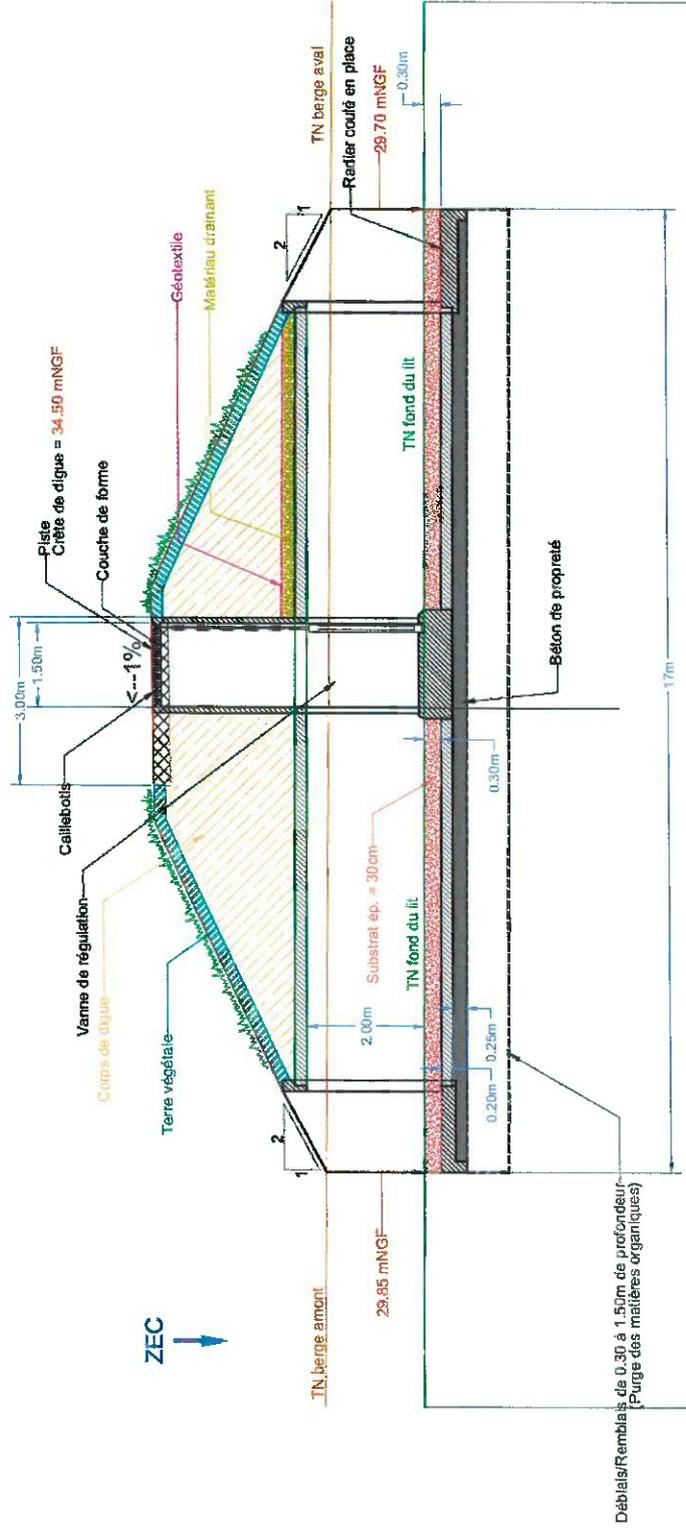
Profil en travers du remblai et de l'ouvrage de régulation le traversant
